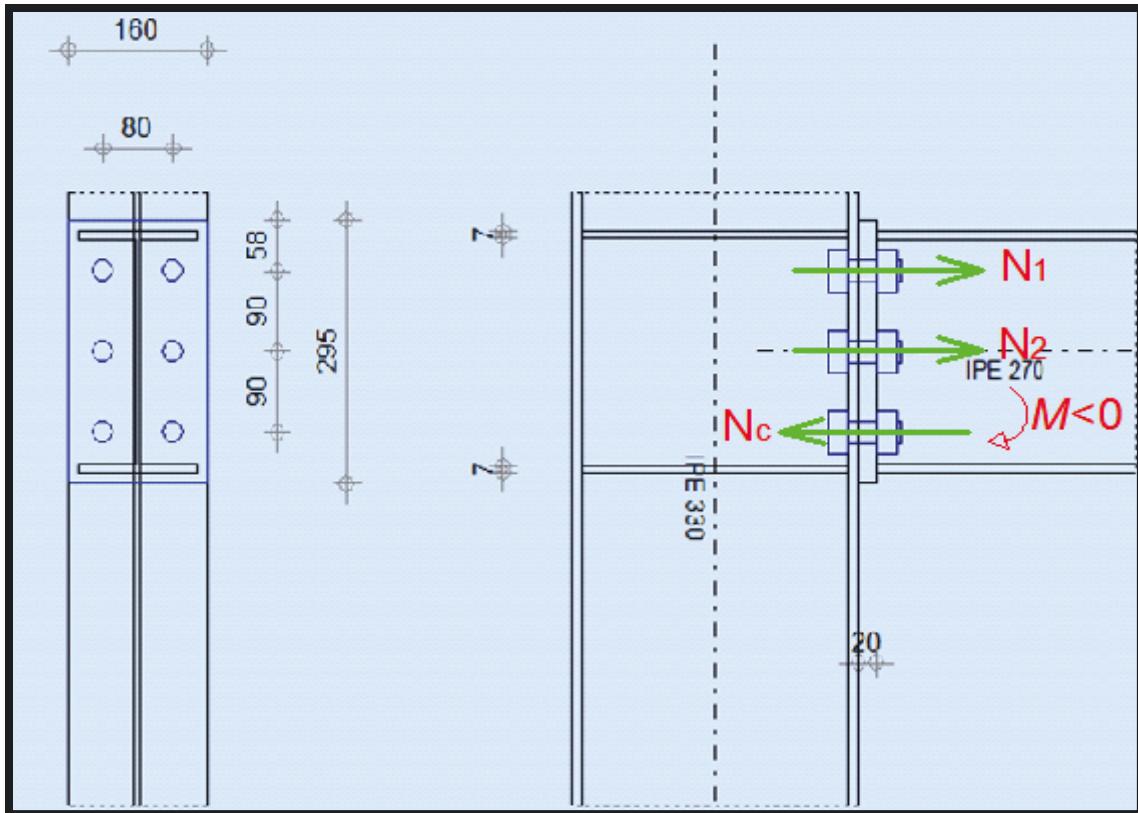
Connexion par boulonnage de la poutre principale - Platine
